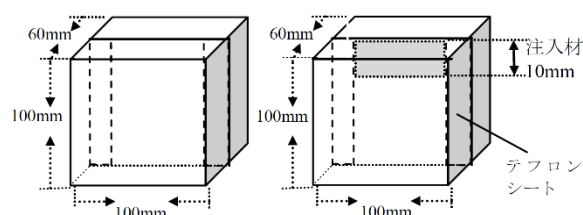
耐久性試験の試験体ひび割れ
